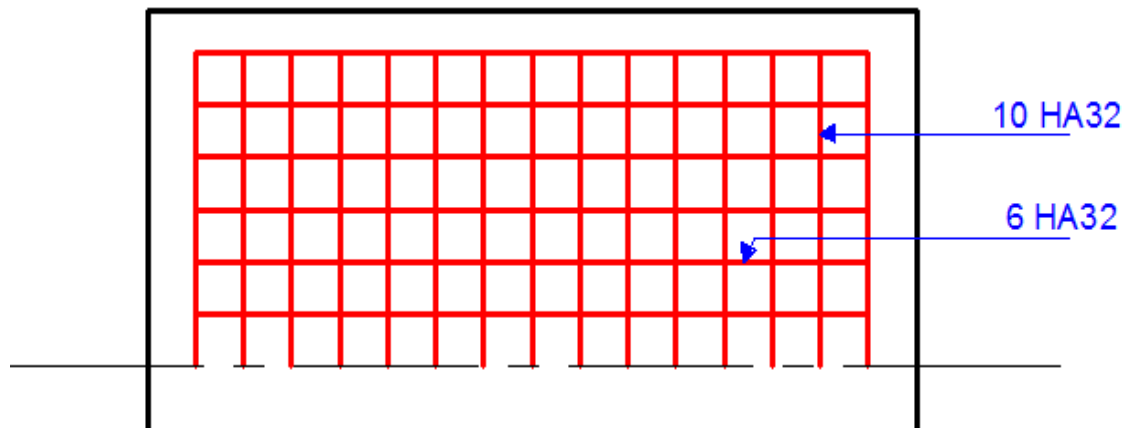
ferrailage de mur en retour (vue en plan)
